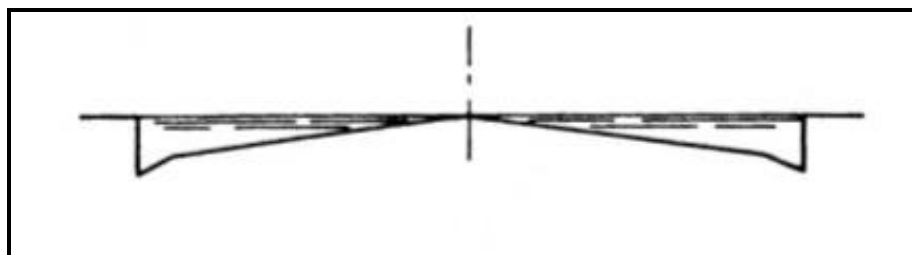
PERFIL TRANSVERSAL TÍPICO DE UNA CALLE PAVIMENTADA.
